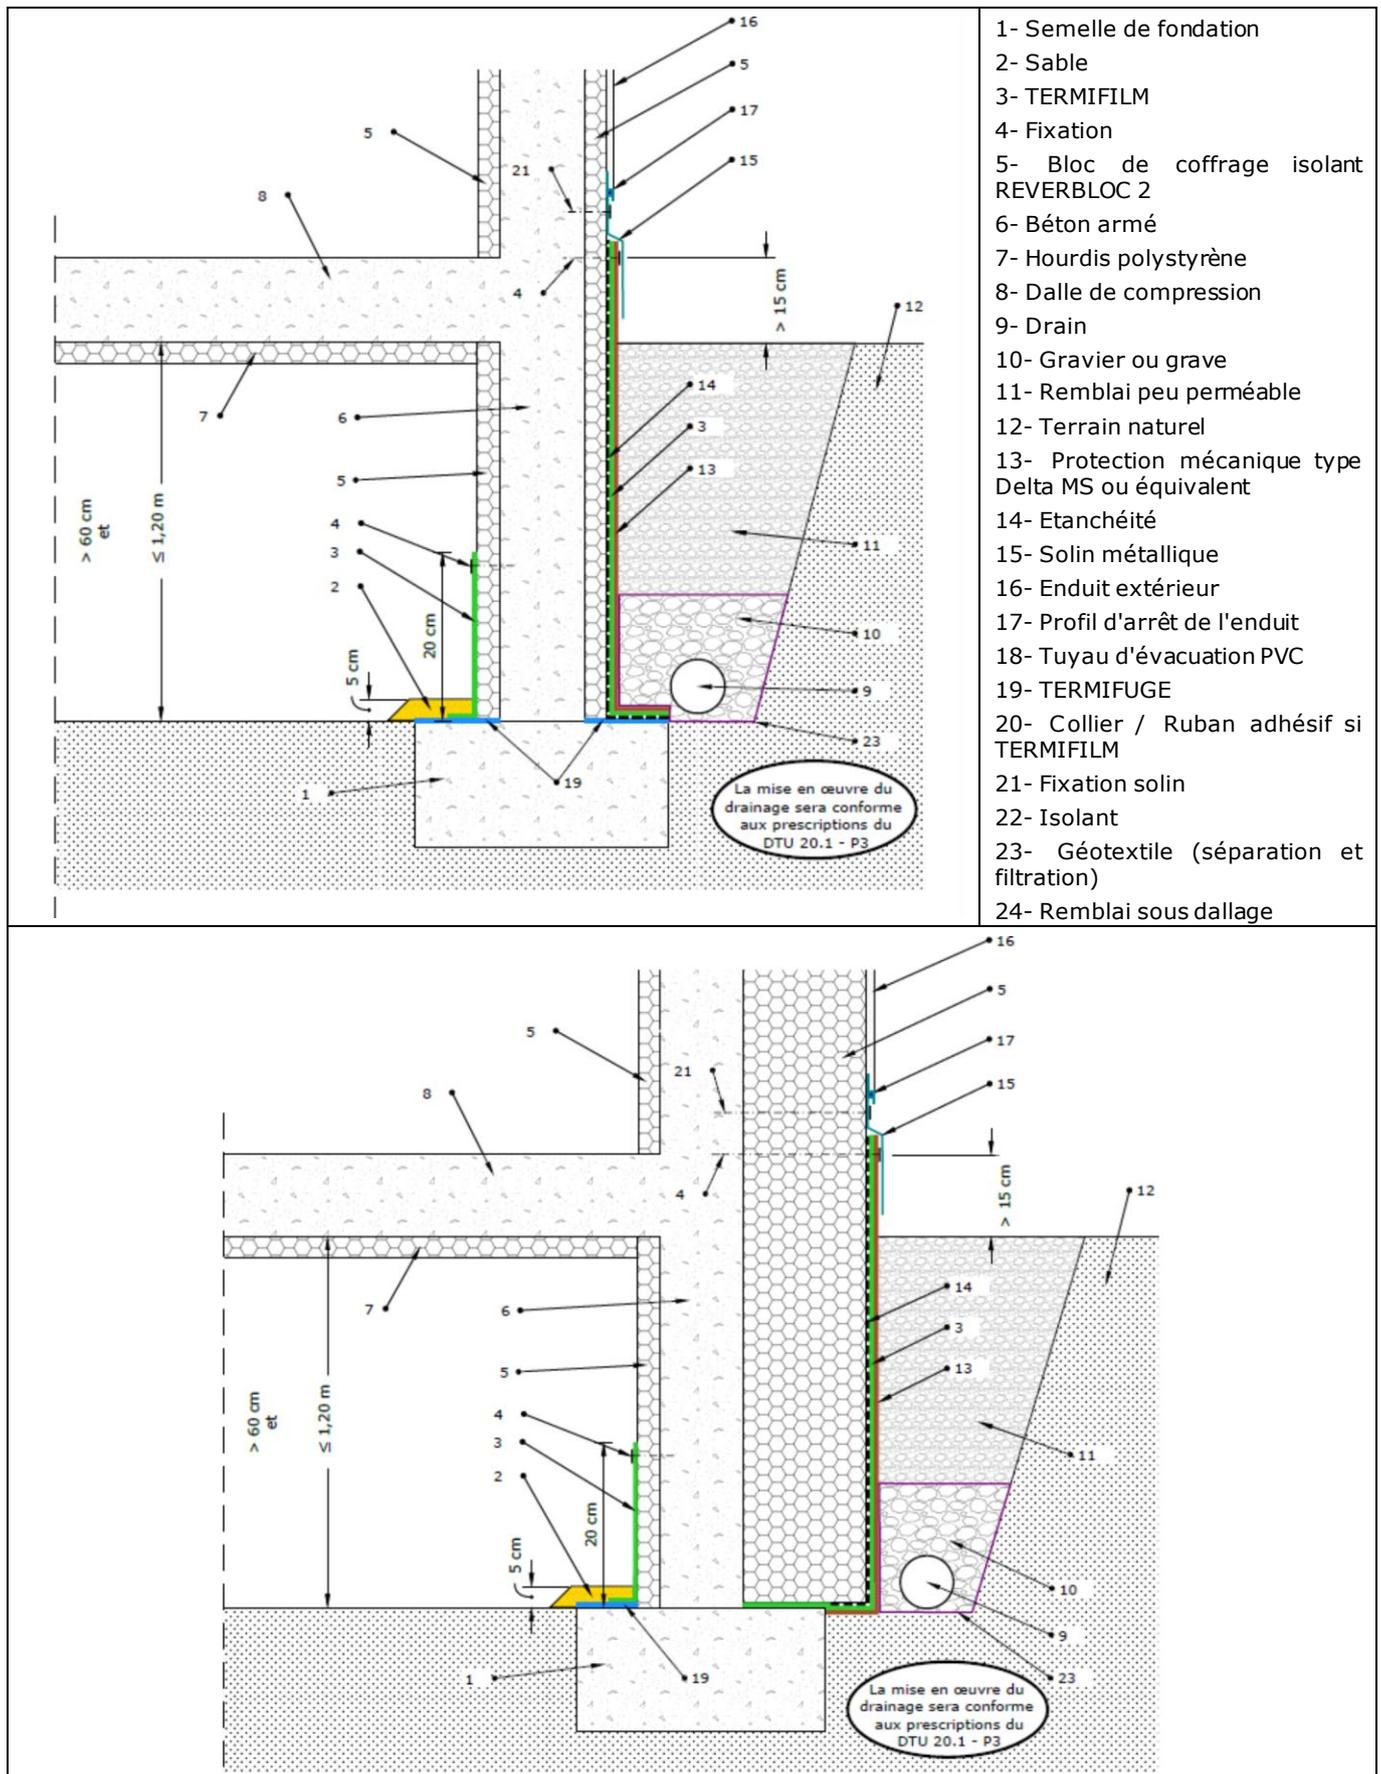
Mur extérieur de vide sanitaire visible – principe avec ou sans isolant en sous face de dalle de plancher
